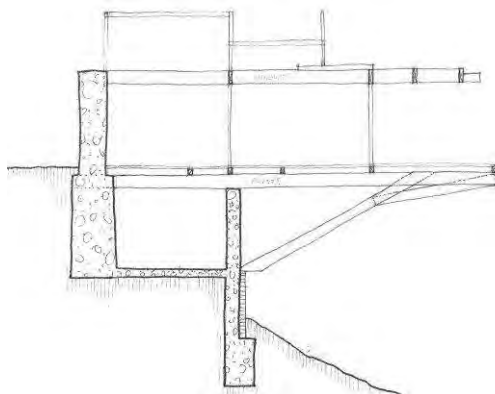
Reparación de las vigas en voladizo de la Casa de la Cascada, mediante un sistema de postensado externo, embebido en el espesor de las vigas de la gran terraza.
